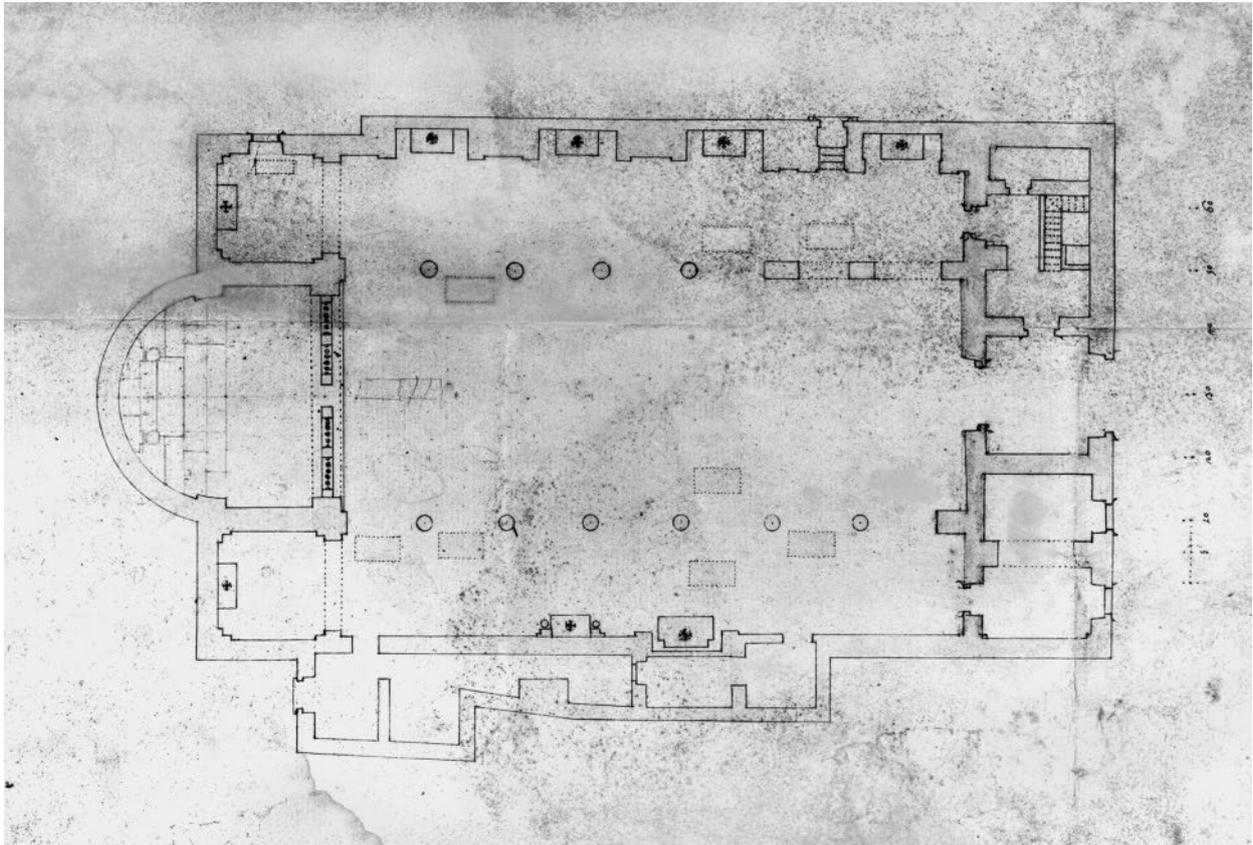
Rom, S. Maria in Monticelli, Grundriss vor 1714 (ehem. Galerie Carrol, München. BHR Fotothek)
